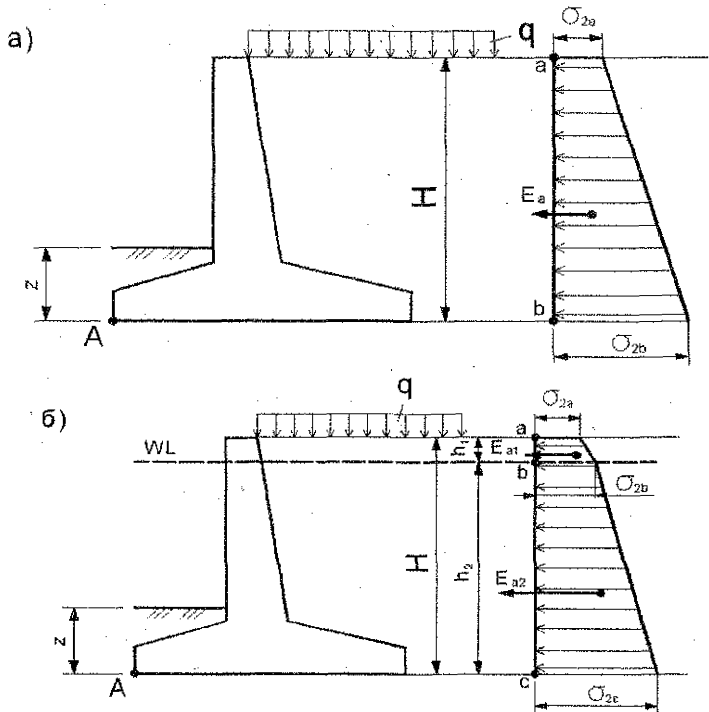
Схемы к определению активного давления грунта на подпорную стенку в период: а) строительства; б) эксплуатации
